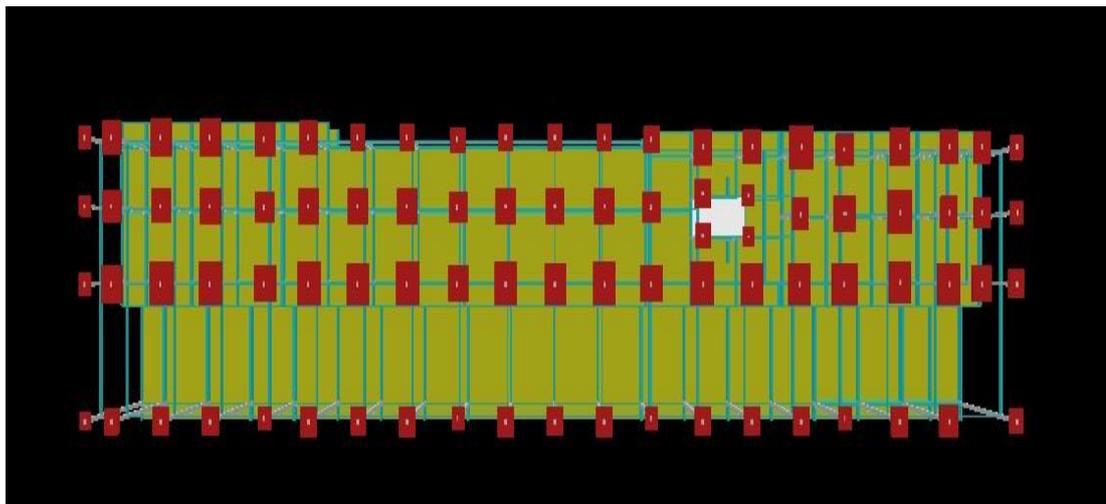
Projeto estrutural com fundação utilizando solo 2
